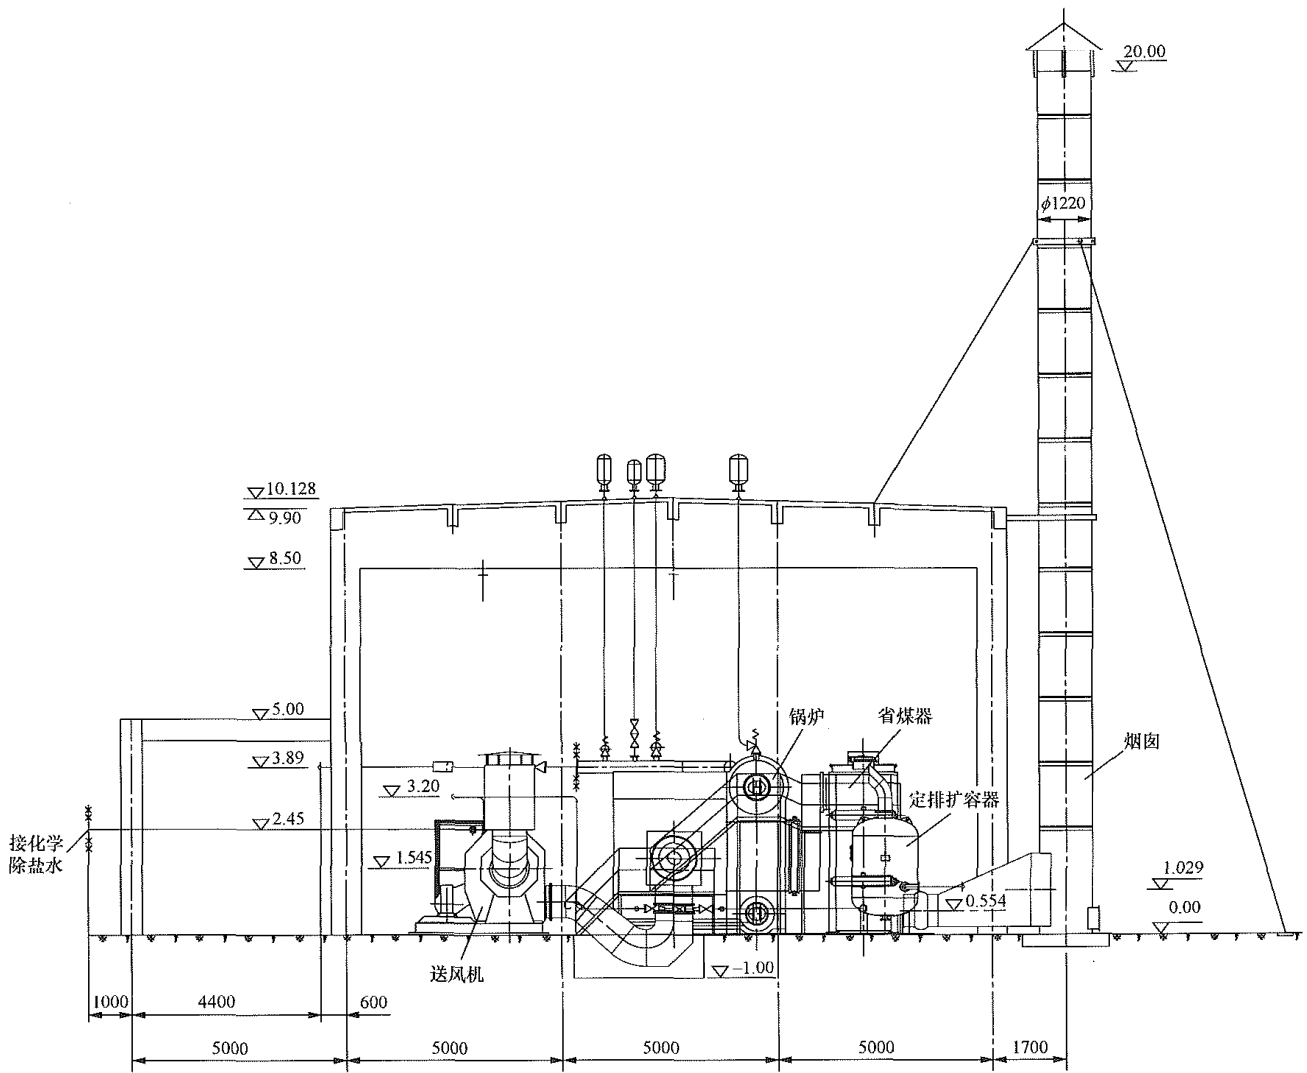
35t/h 燃油、燃气辅助锅炉房平面布置图 (室内布置方案)
